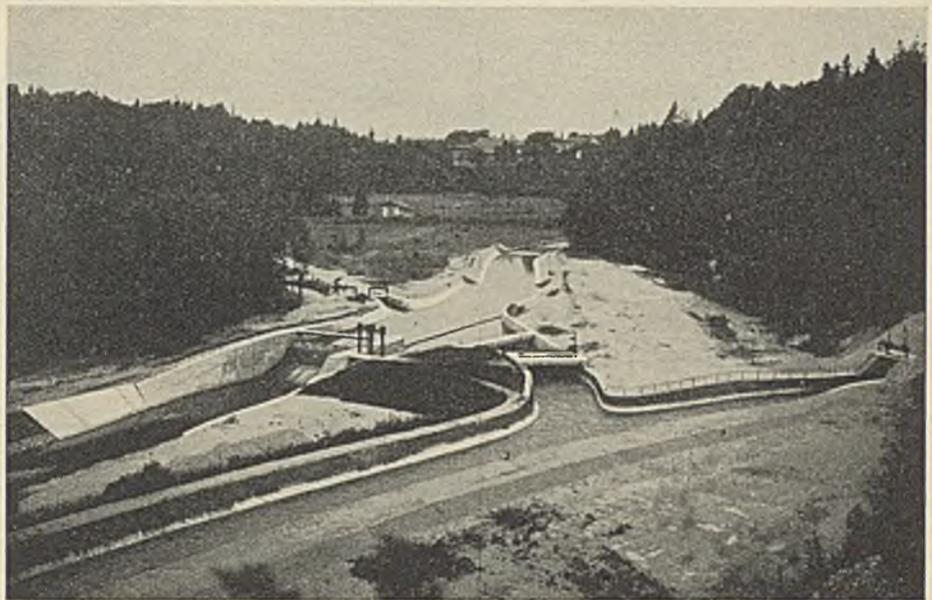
Schlierachwehr, Stollenauslauf A, Einmündung des Wallenburger-Kanals.
